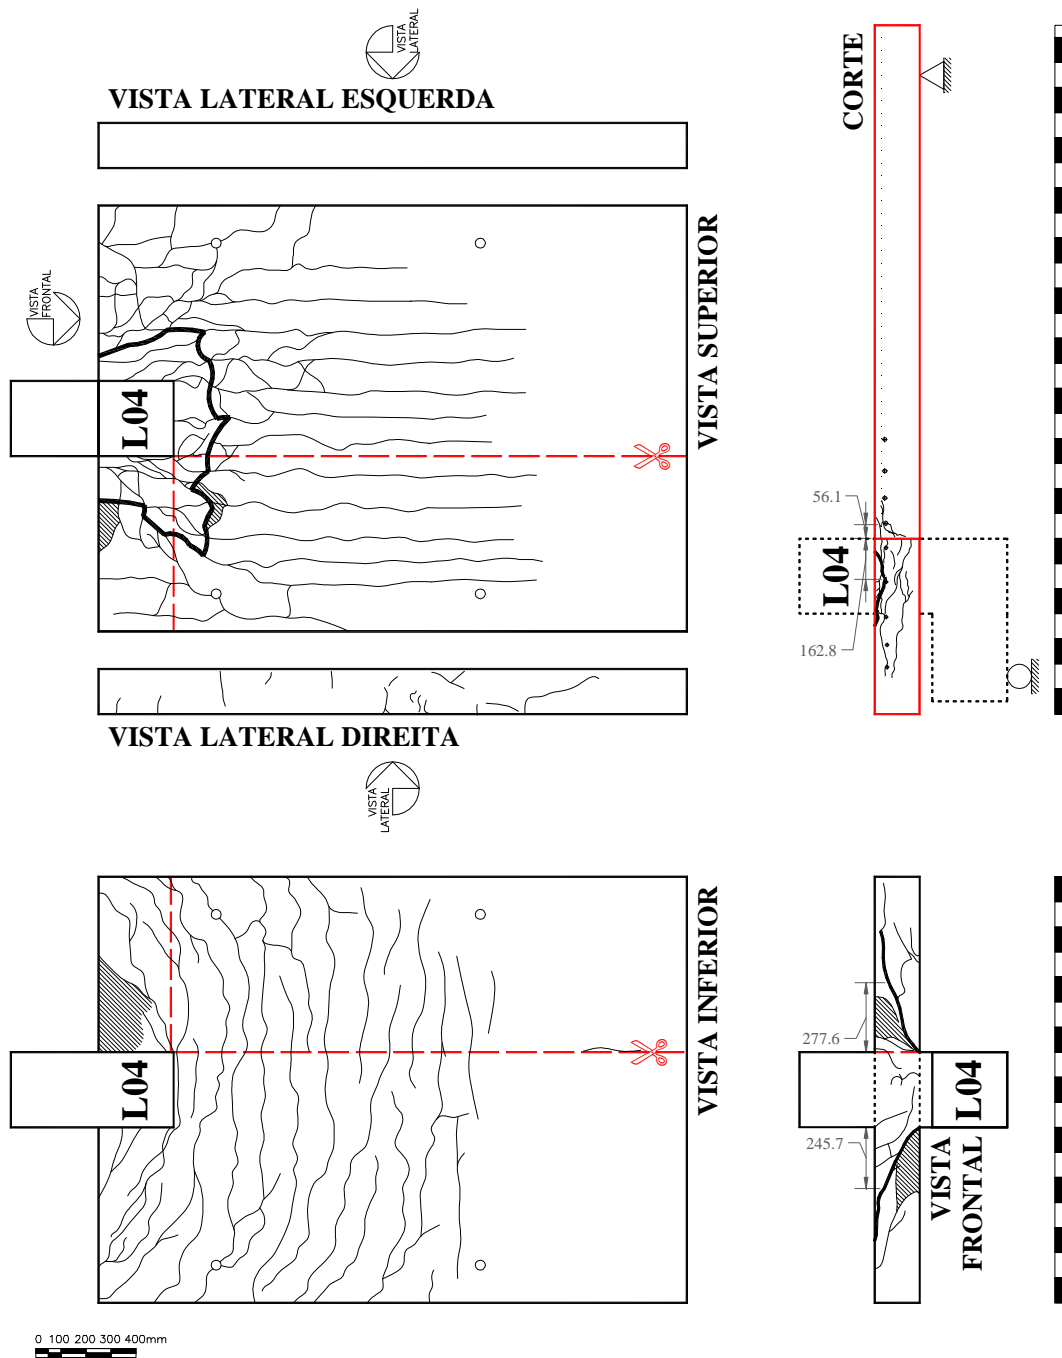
Padrão de fissuração da laje L04
